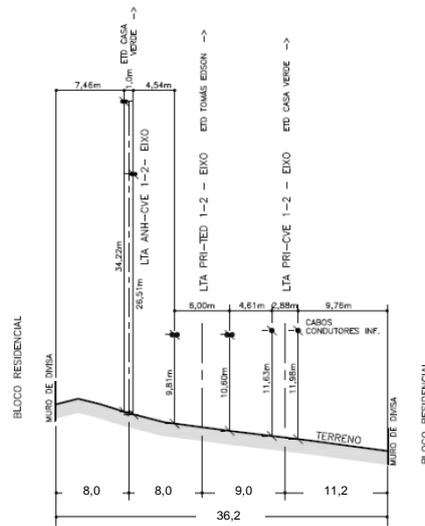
Trecho SE PIRITUBA – RAE LAPA (início reconstrução LT PRI – CVE)
